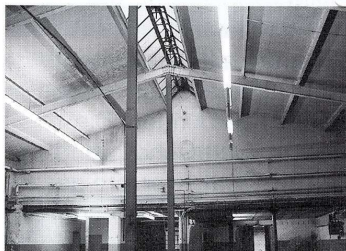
1949 umgebaute Halle mit Durchgang in ehemaliges Mühlengebäude, 1994
